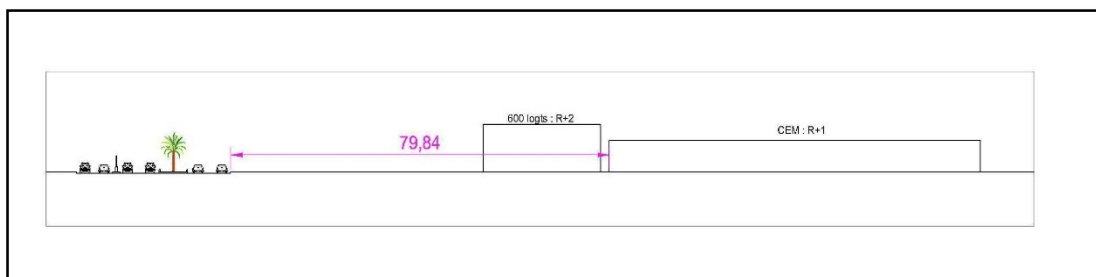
coupe transversale sur le terrain. Source : Auteur
